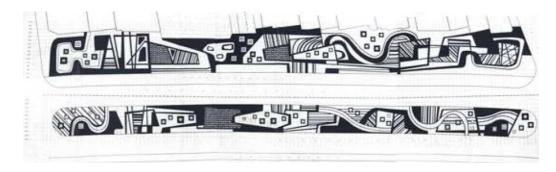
PLANTA PASEO COPACABANA. MARX. FRAGMENTO DE LA PLANIMETRÍA Fuente: Reyes, 2011.
